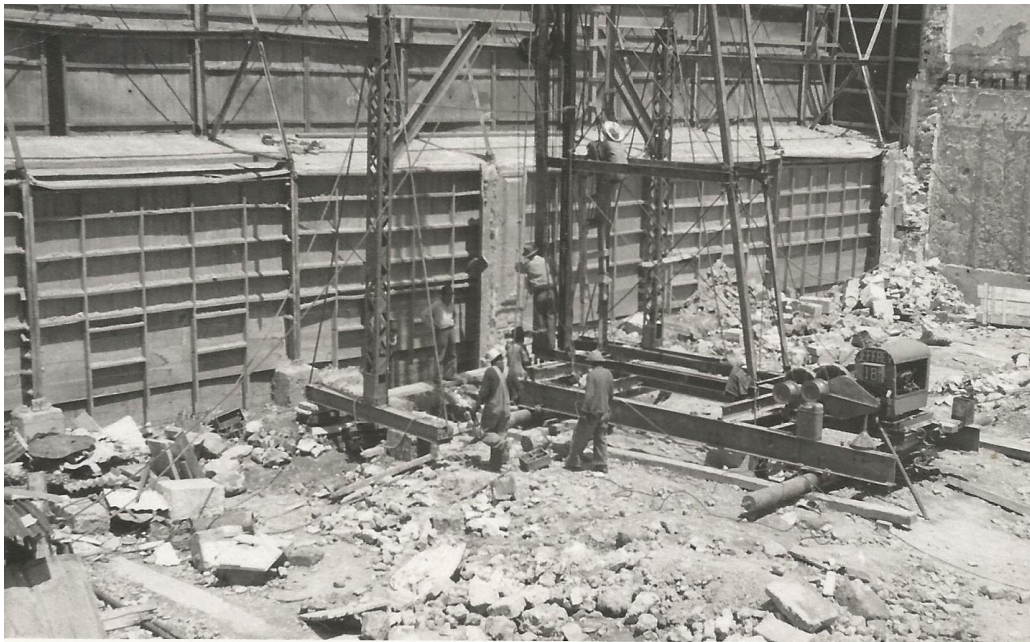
VIGAS "H" APOYÁNDOSE EN LA ATAGUÍA.
